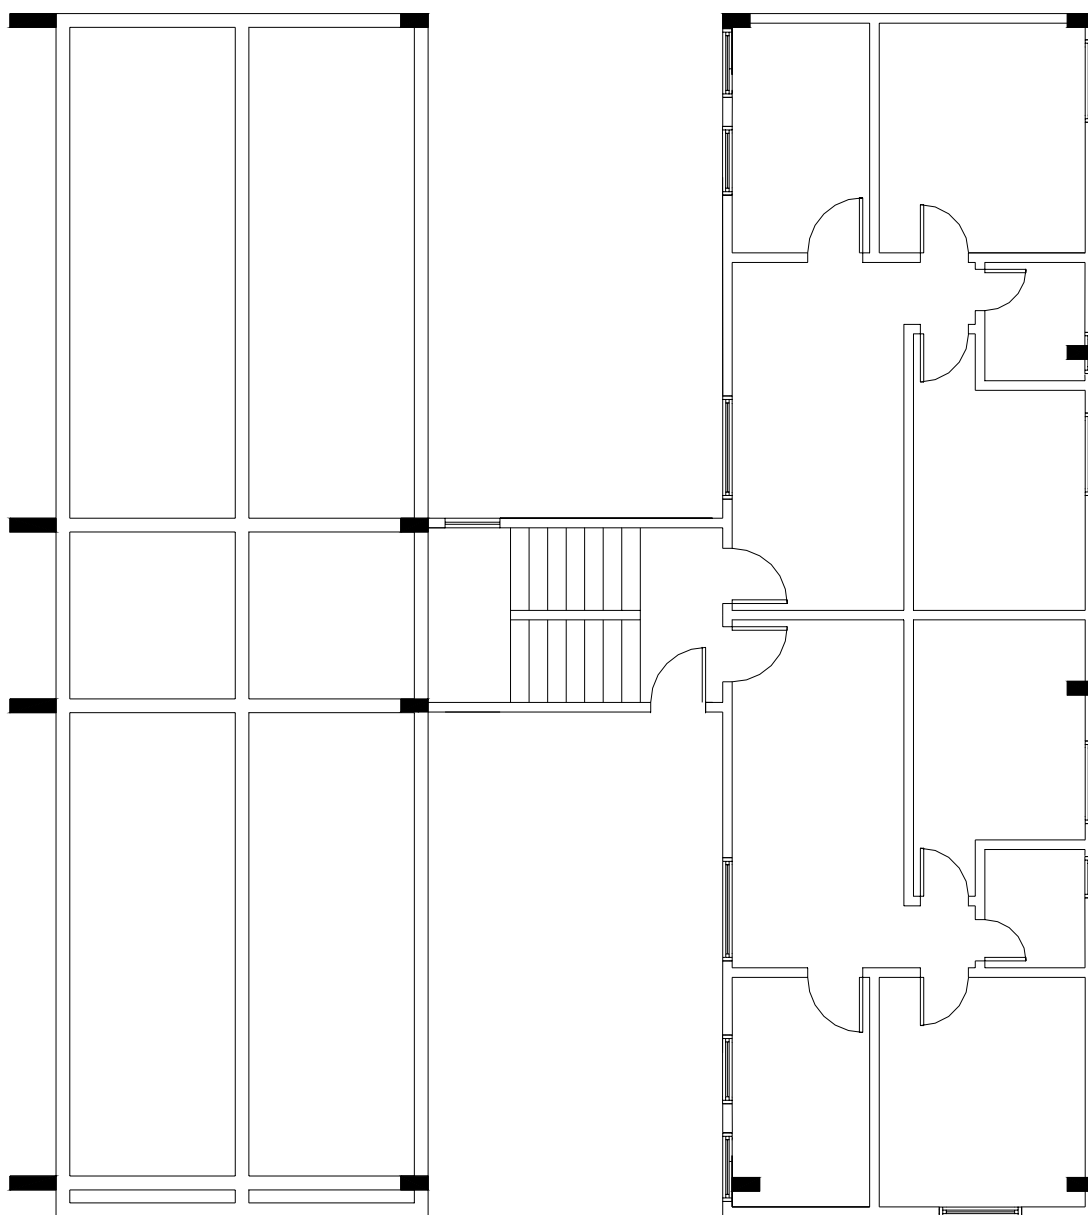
Residencial “J” – Bloco 4 – Primeira solução de vigamento de pilotis
